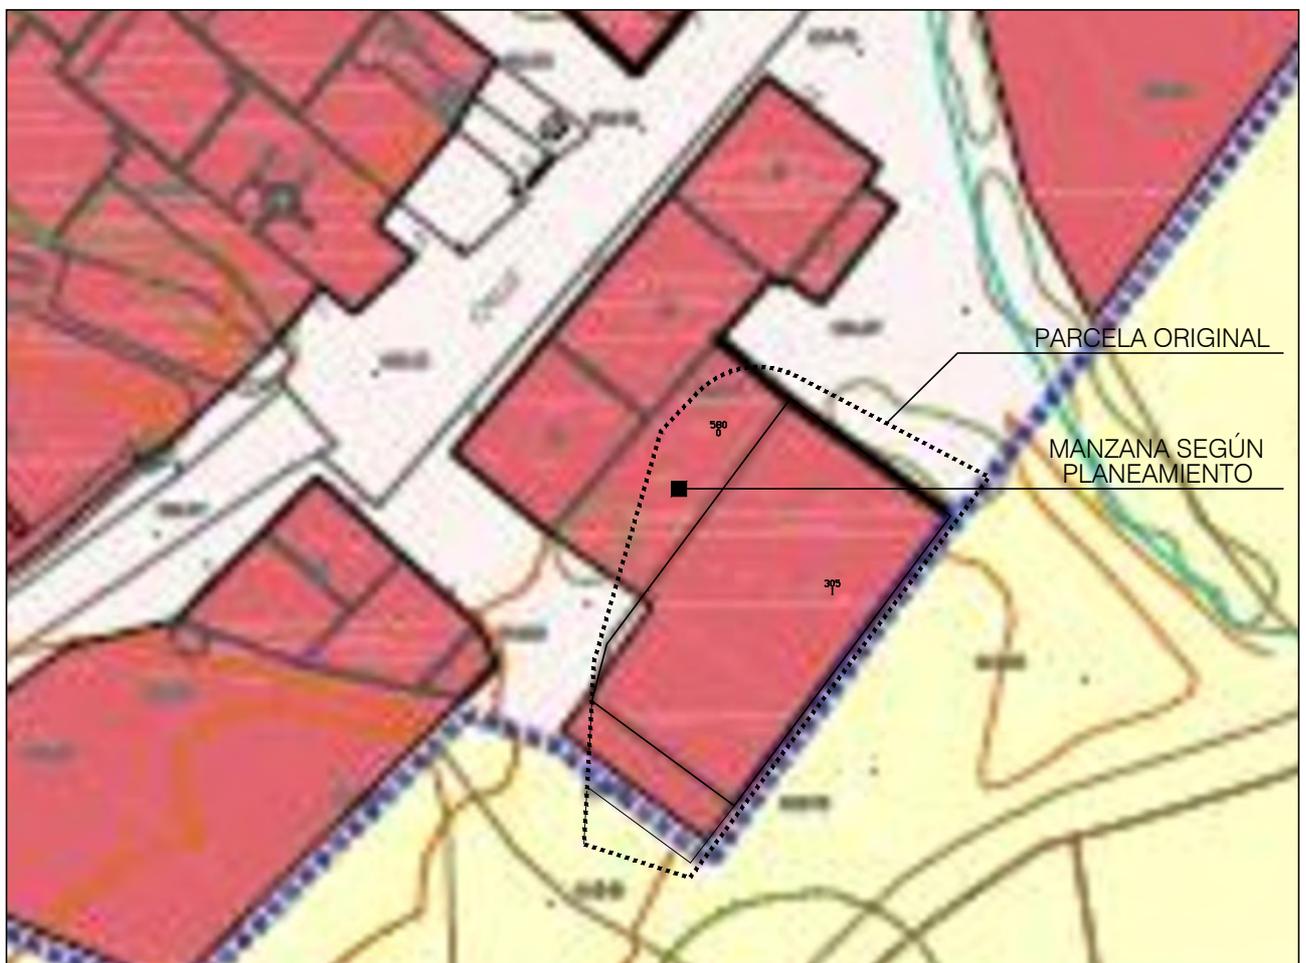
Parcela original y alineaciones del planeamiento. Escala 1/500
